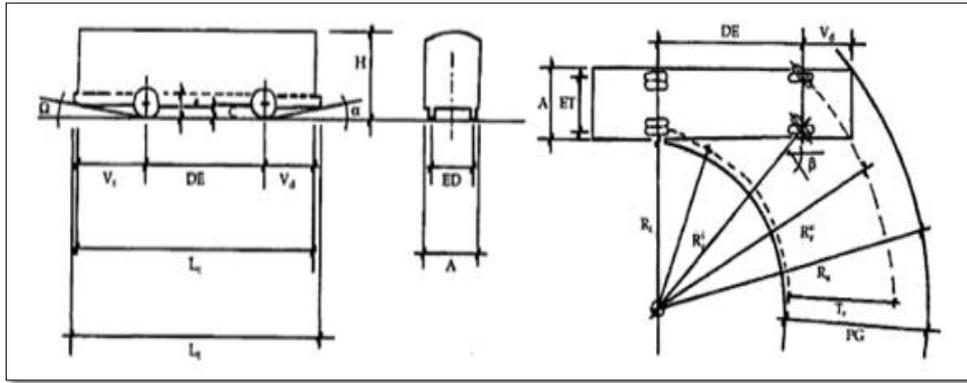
13 Dimensiones del autobús; Fuente, (Molinero, 2002)
